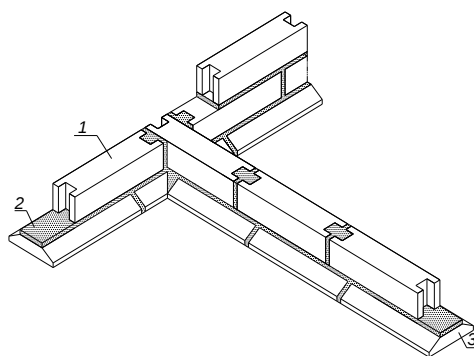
Вариант сборного ленточного фундамента: 1-фундаментный блок, ФБС; 2-цементно-песчаный раствор; 3-фундаментная плита, ФЛ
